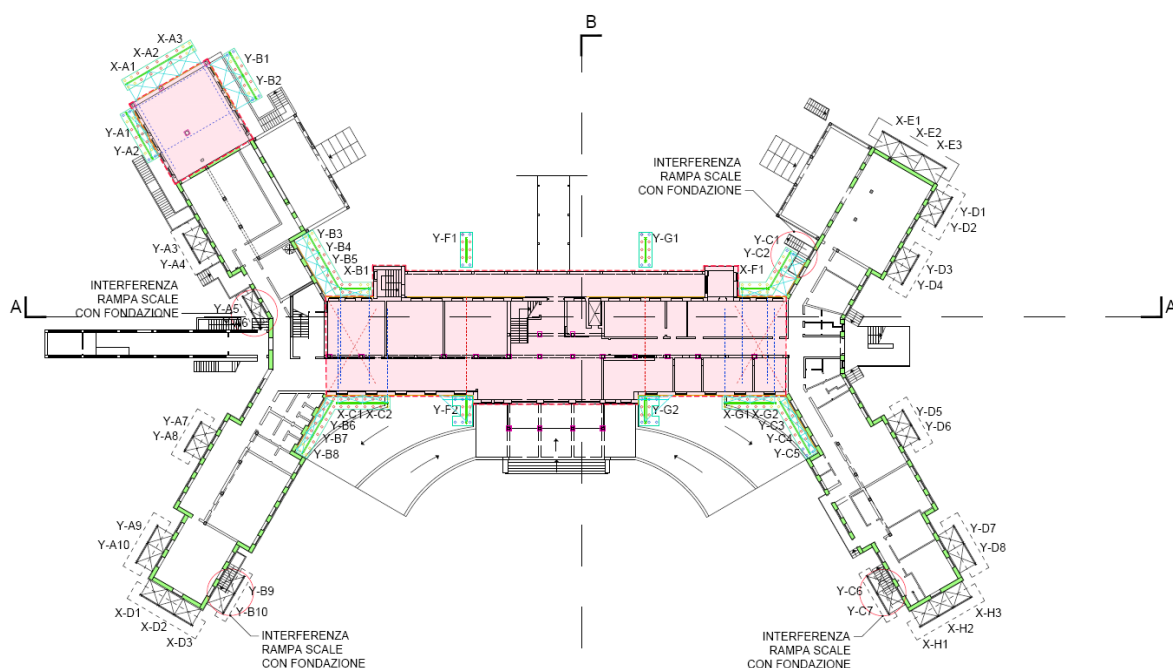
Pianta piano rialzato, unità strutturali di interesse (colore rosa), schema fondazioni e identificazione setti
